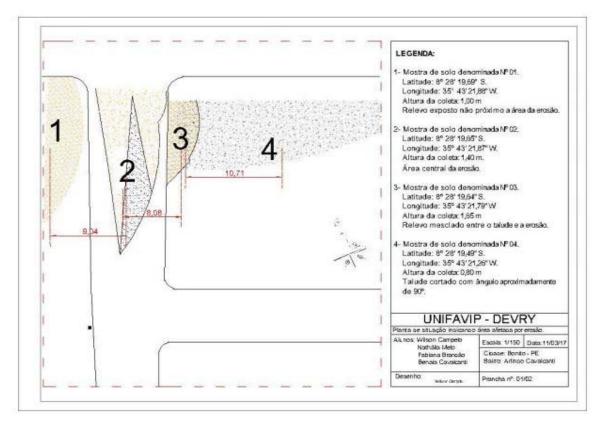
Cópia da Planta de situação mostrando a área afetada pela erosão. Fonte: Os autores.
